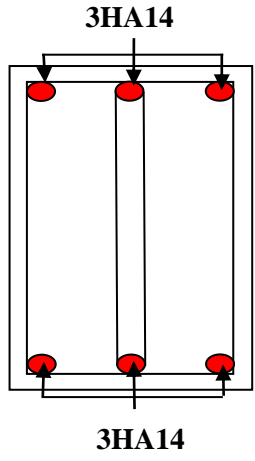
Exemple de Schéma de ferrailage d'une poutre principale.
